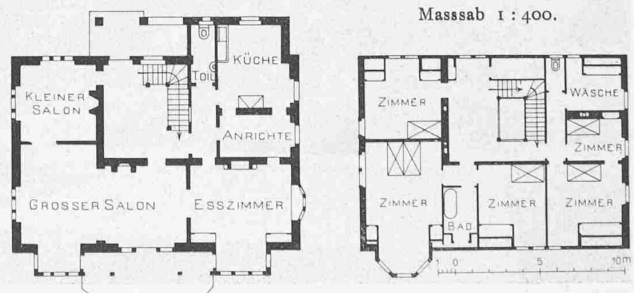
u. 2. Grundrisse vom Erdgeschoss und I. Stock der Villa Gardy.
